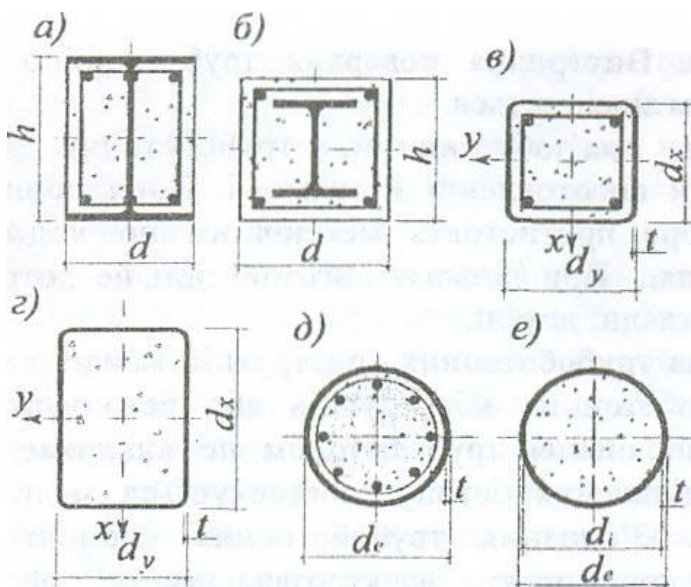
Основные типы поперечных сечений сталебетонных элементов
